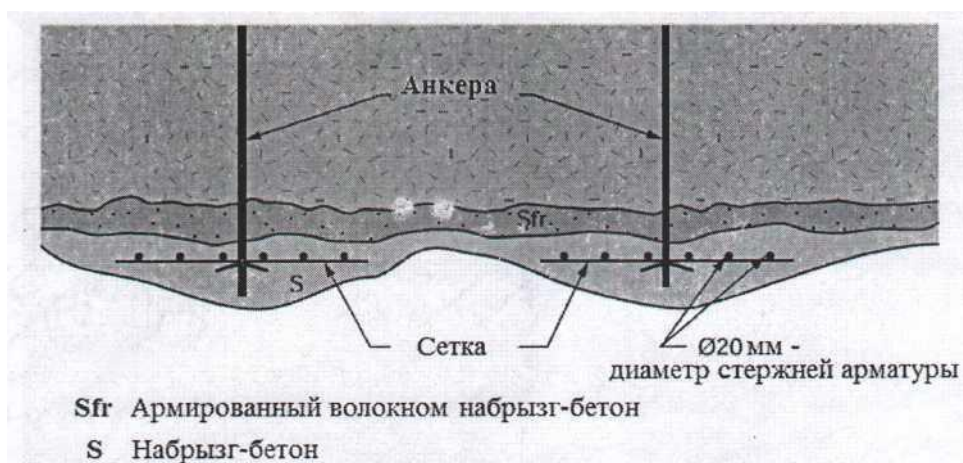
Схема установки крепления с армокаркасом RRS
